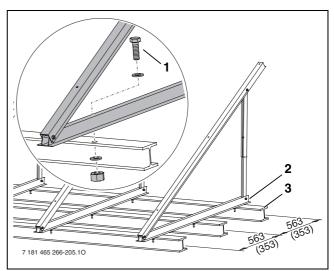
Flachdachständer auf Doppel-T-Träger, Maße in mm (Klammerwert = waagerechte Ausführung
